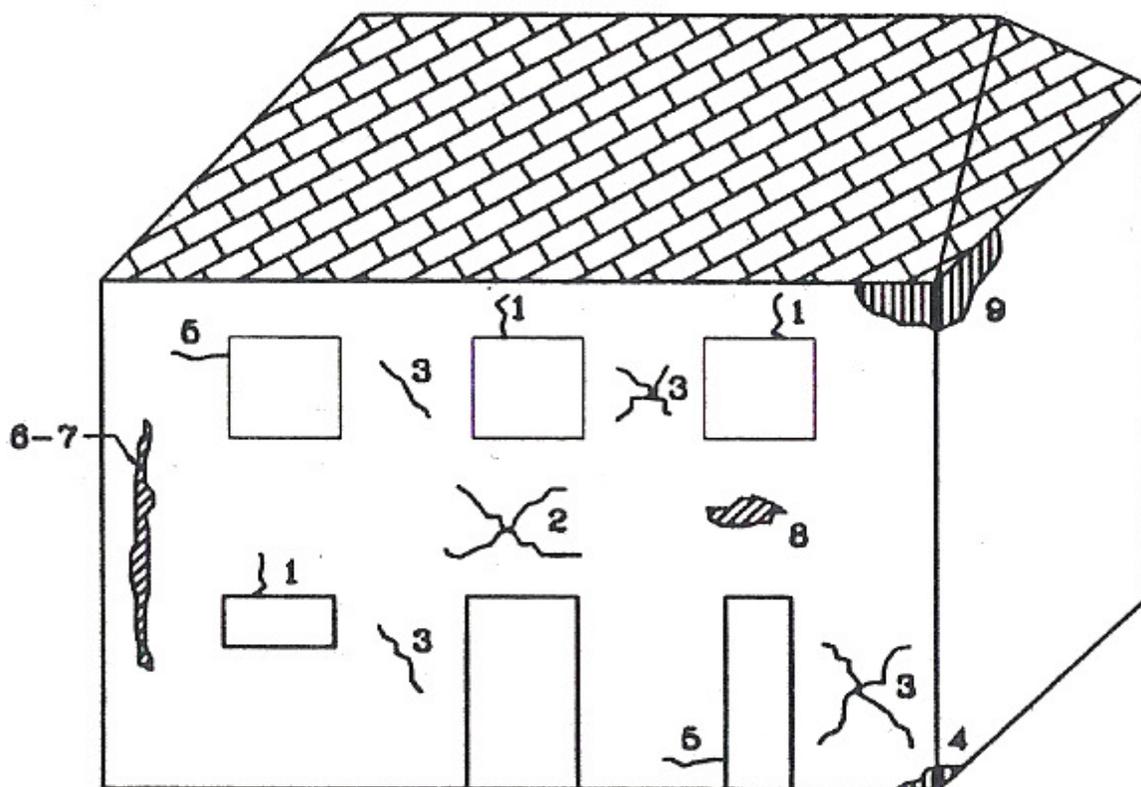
Tipos de grietas en el sistema resistente vertical de mampostería no reforzada.
